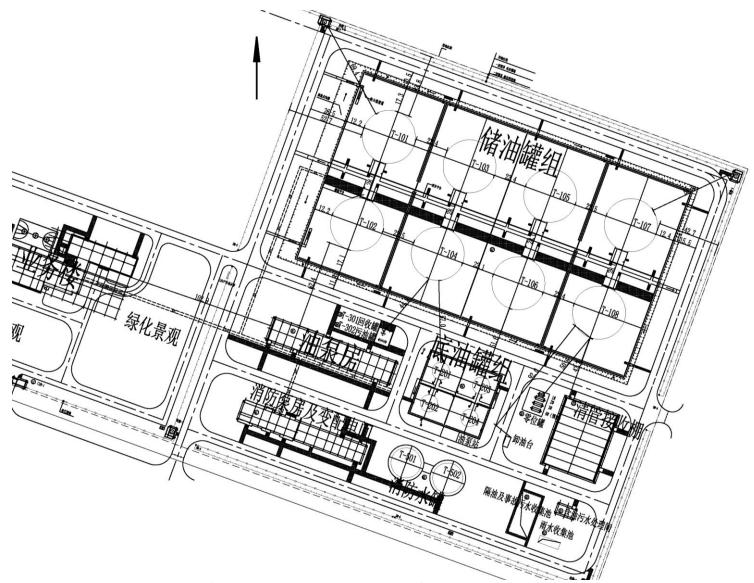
本项目平面布置示意图(单位: m,箭头指向为北)
